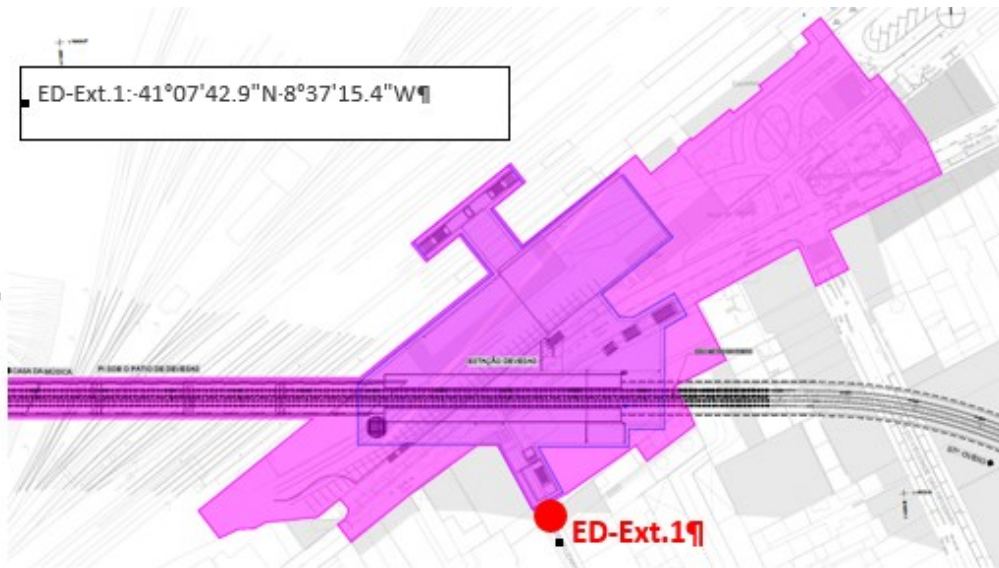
Pontos de monitorização junto Estação Devesas (ruído – construção)
